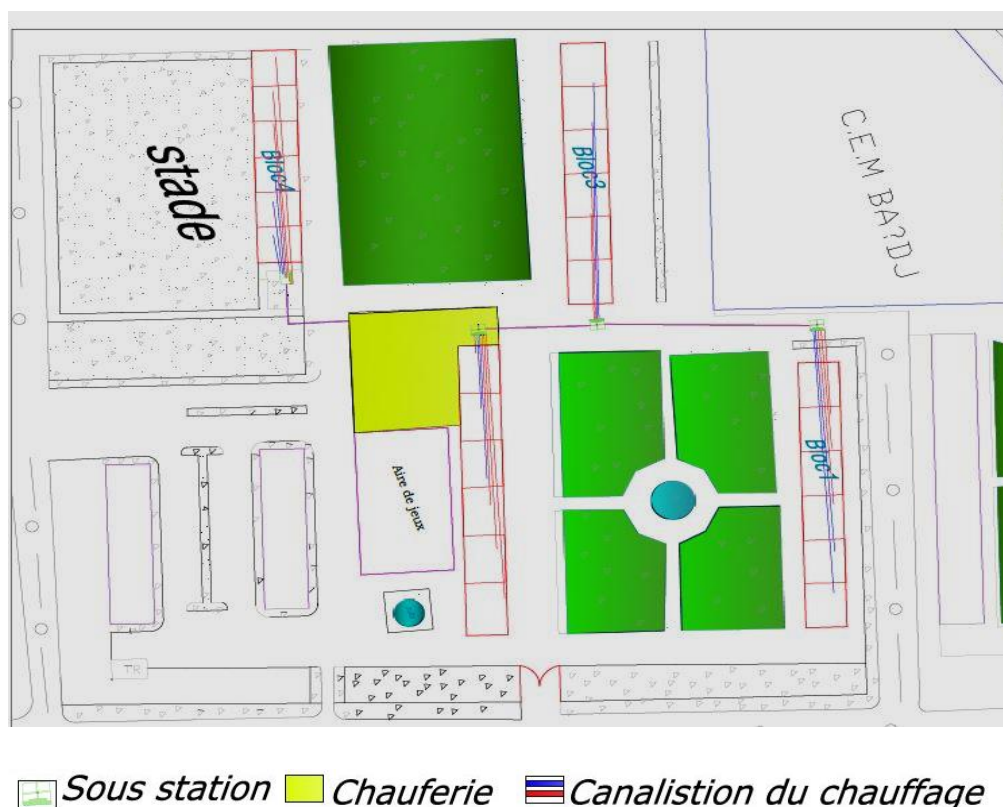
Plan de réseau de chauffage horizontal
